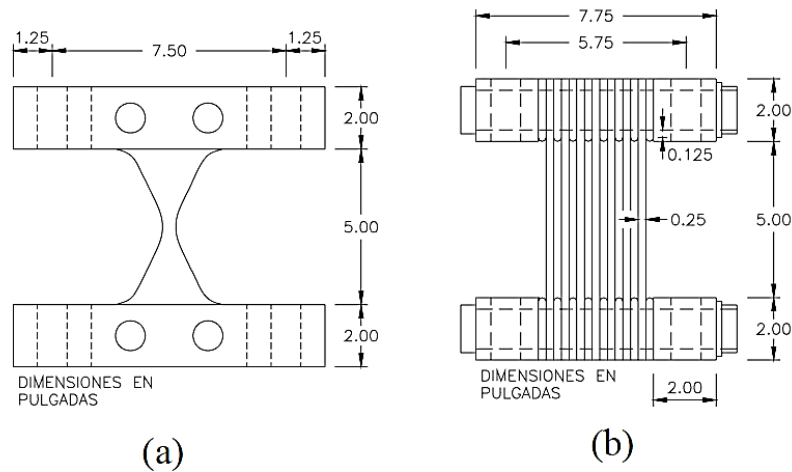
7. Sistema ADAS (a) Dimensiones, (b) conexión típico planchas en paralelo (Whittaker et al., 1989).
